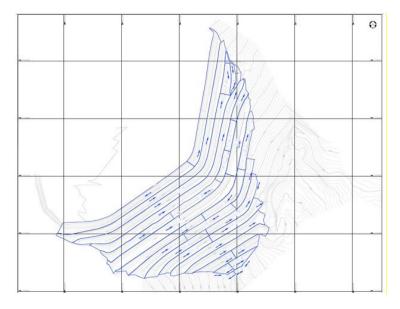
Arranjo para verificação hidráulica do sistema de drenagem das bermas
